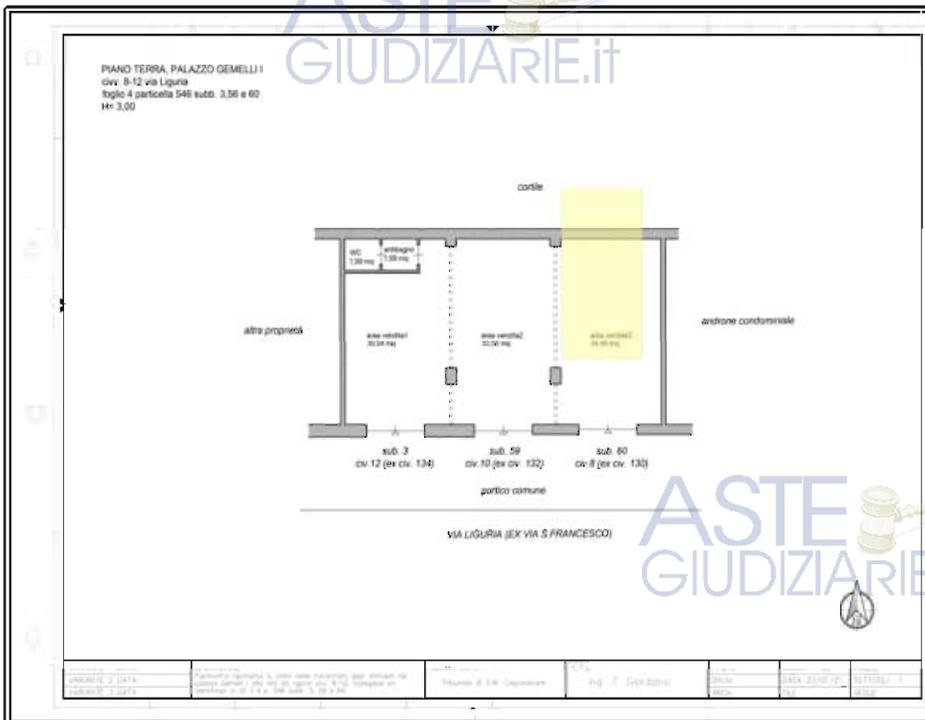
Pianta del minimarket con evidenziazione del LOTTO3
